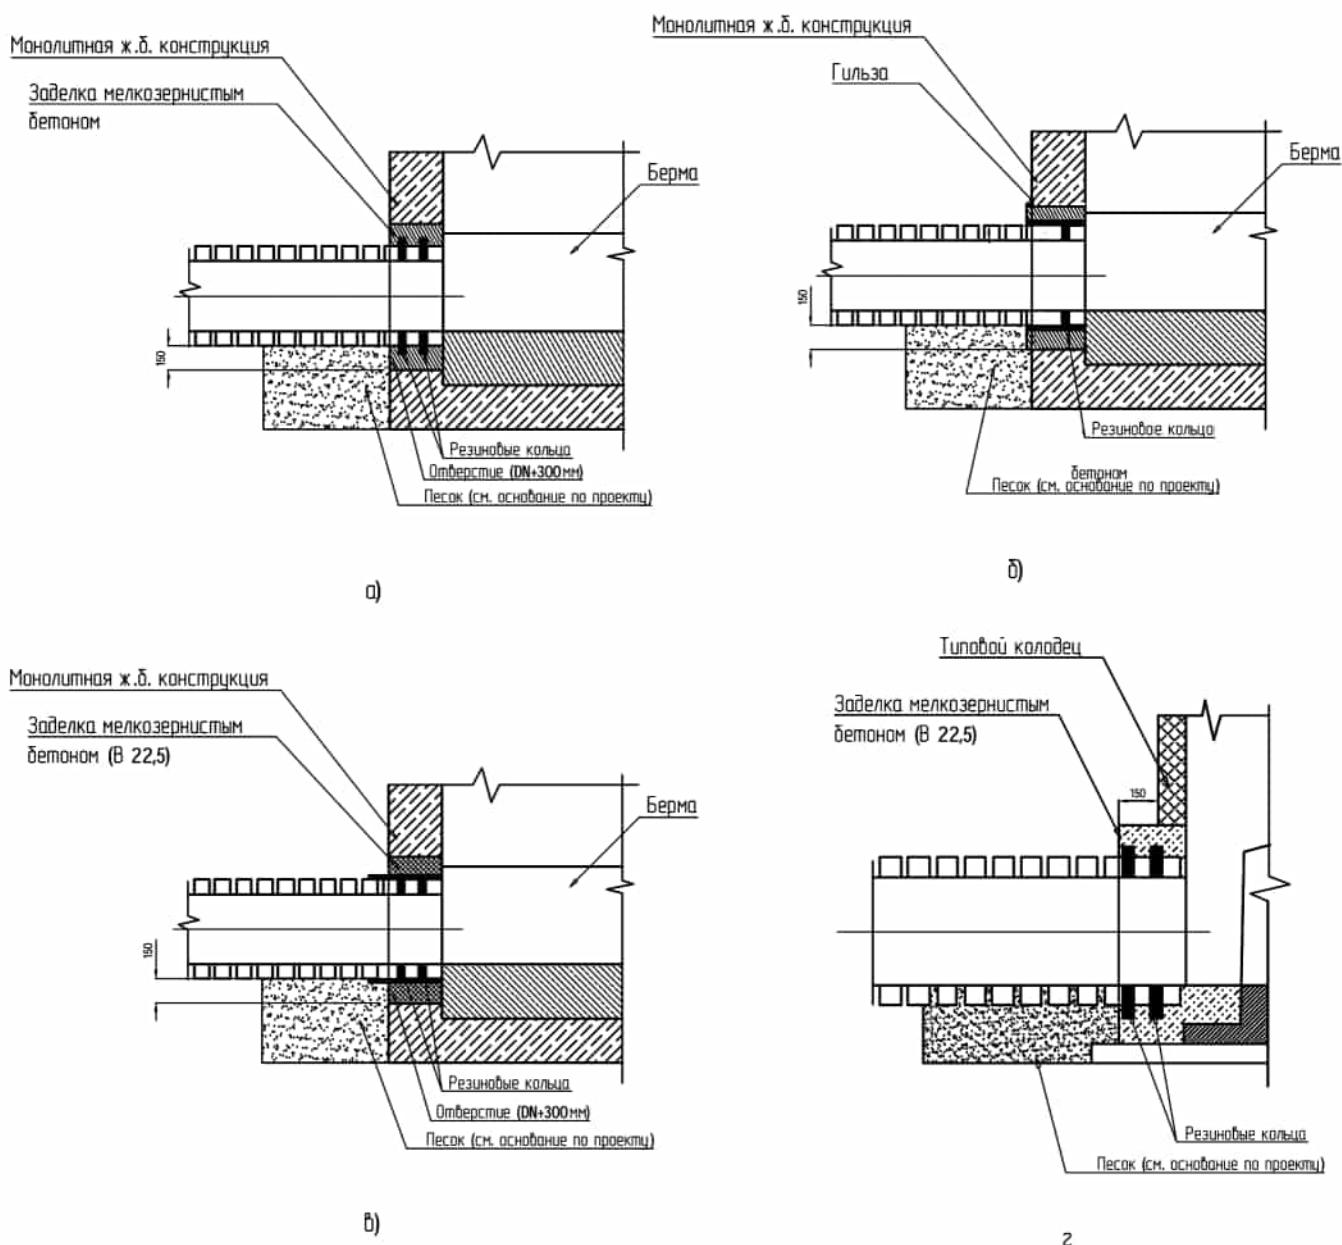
Проход трубопровода через колодцы из железобетона
